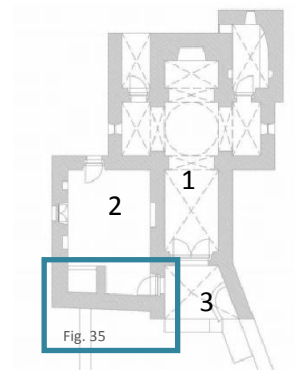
Proposta de planta da Ermida de Nª Sª do Paraíso;
